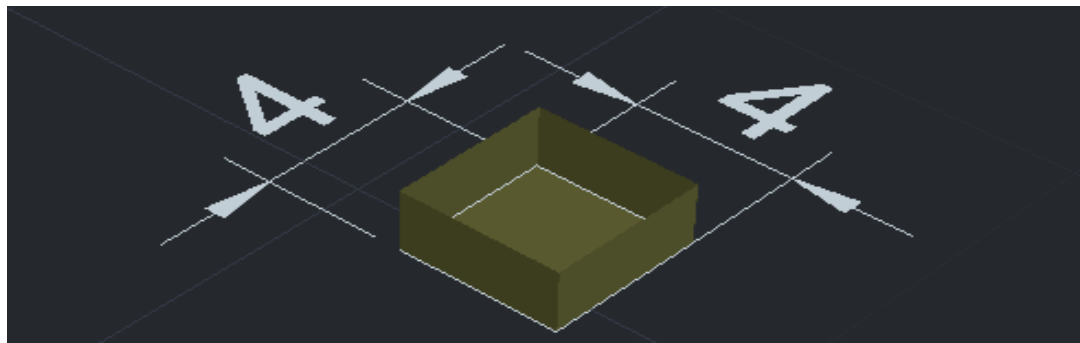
Tanque de ensilaje. AutoCAD 3D. Fuente: Elaboración propia
